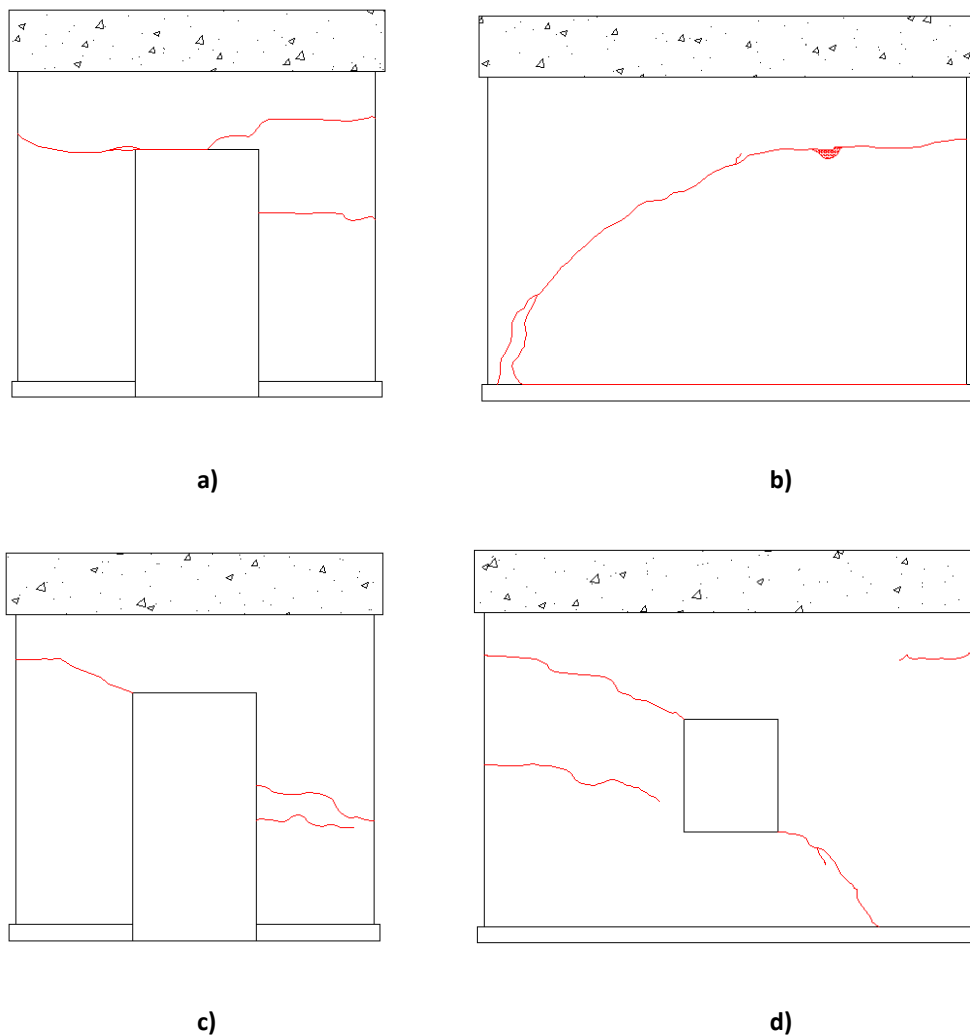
Fissuração após o primeiro ciclo: a) Fachada Este b) Fachada Norte c) Fachada Oeste d) Fachada Sul
